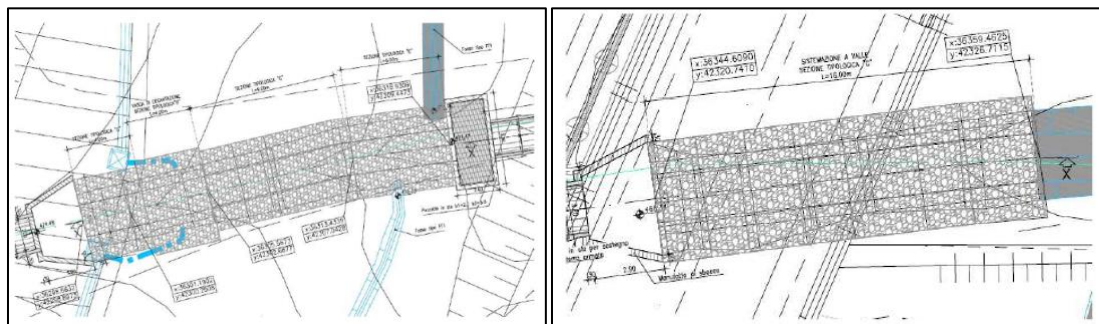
Stralcio planimetrico tratto intermedio a monte del TP60 e Stralcio planimetrico inalveazione a valle del TP60
